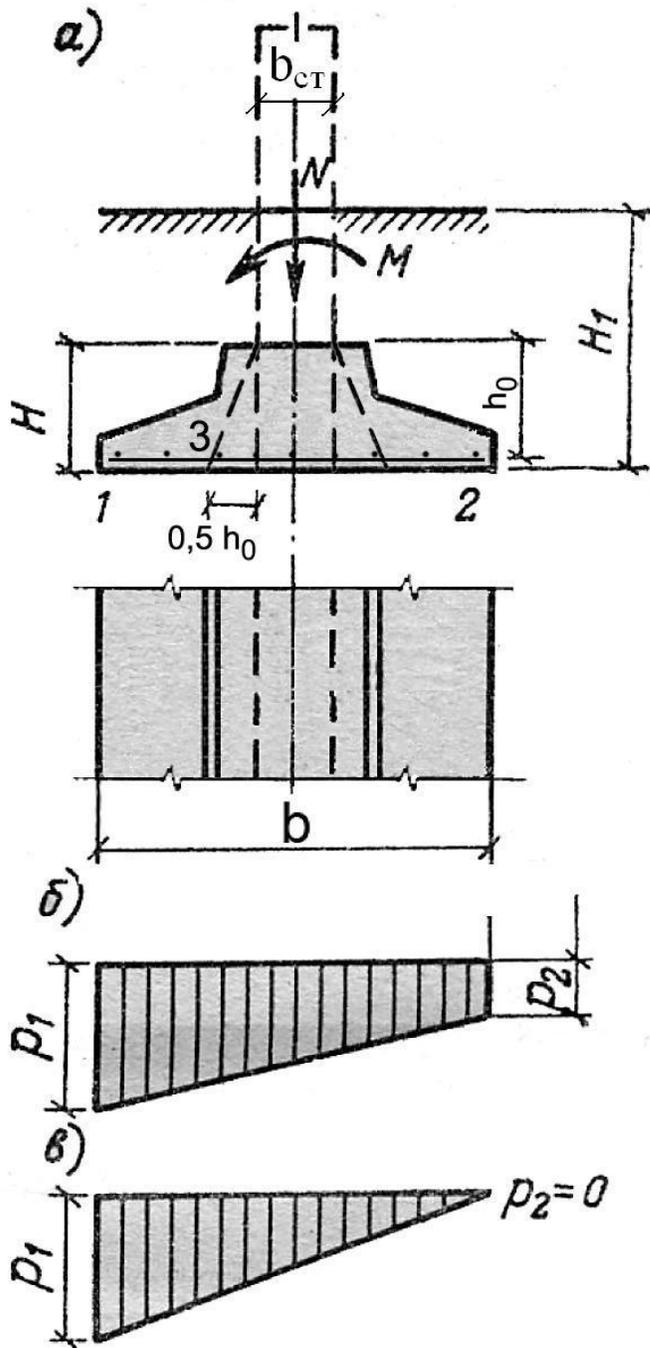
К расчету основания под ленточным фундаментом:
